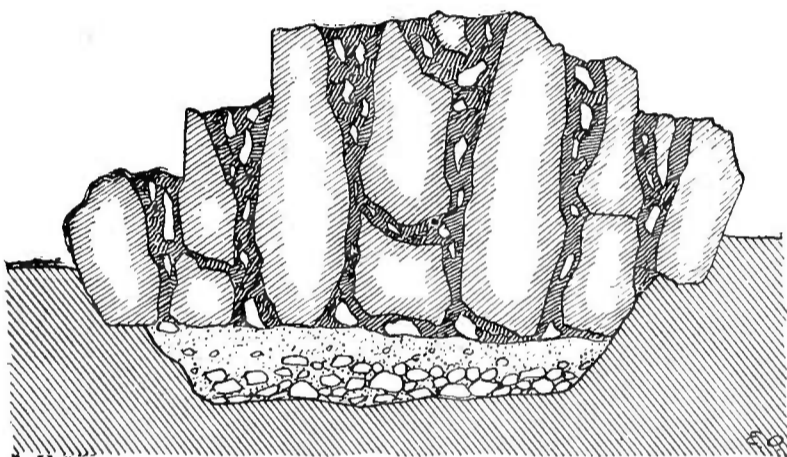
Construction d'une rocaille. Disposition des pierres principales. (D'après Le Garden.)
